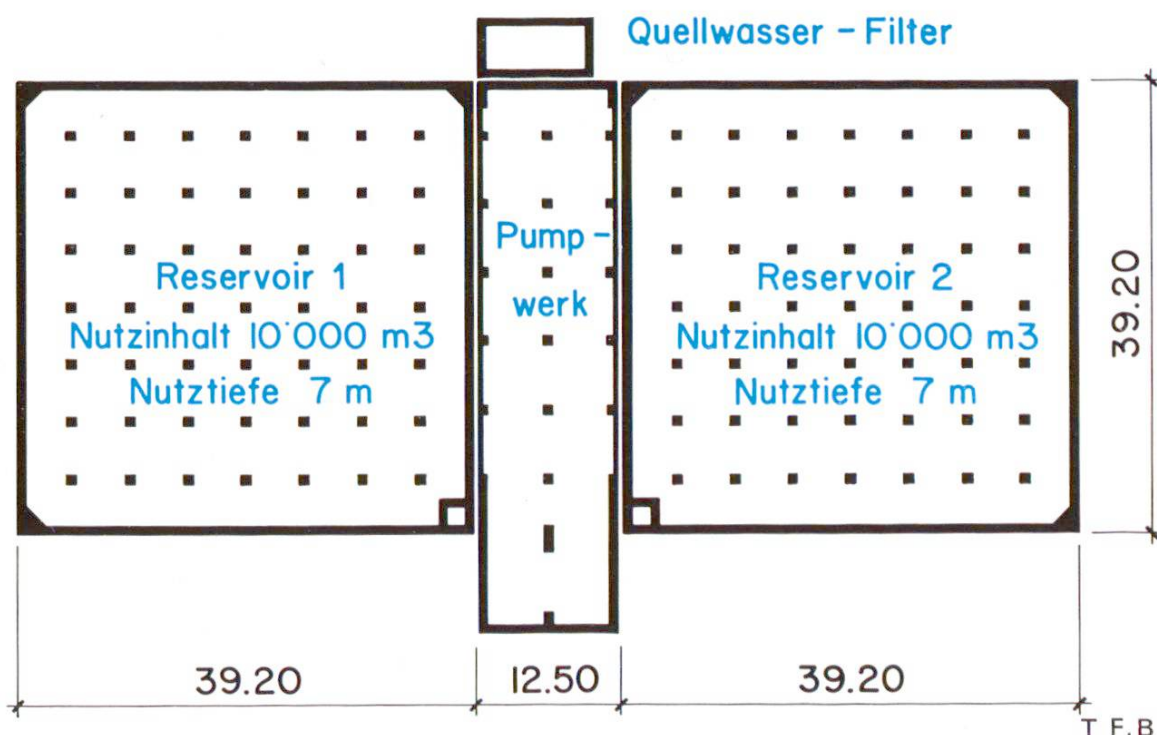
Schematischer Grundriss der Reservoiranlagen «Lyren» Zürich.
